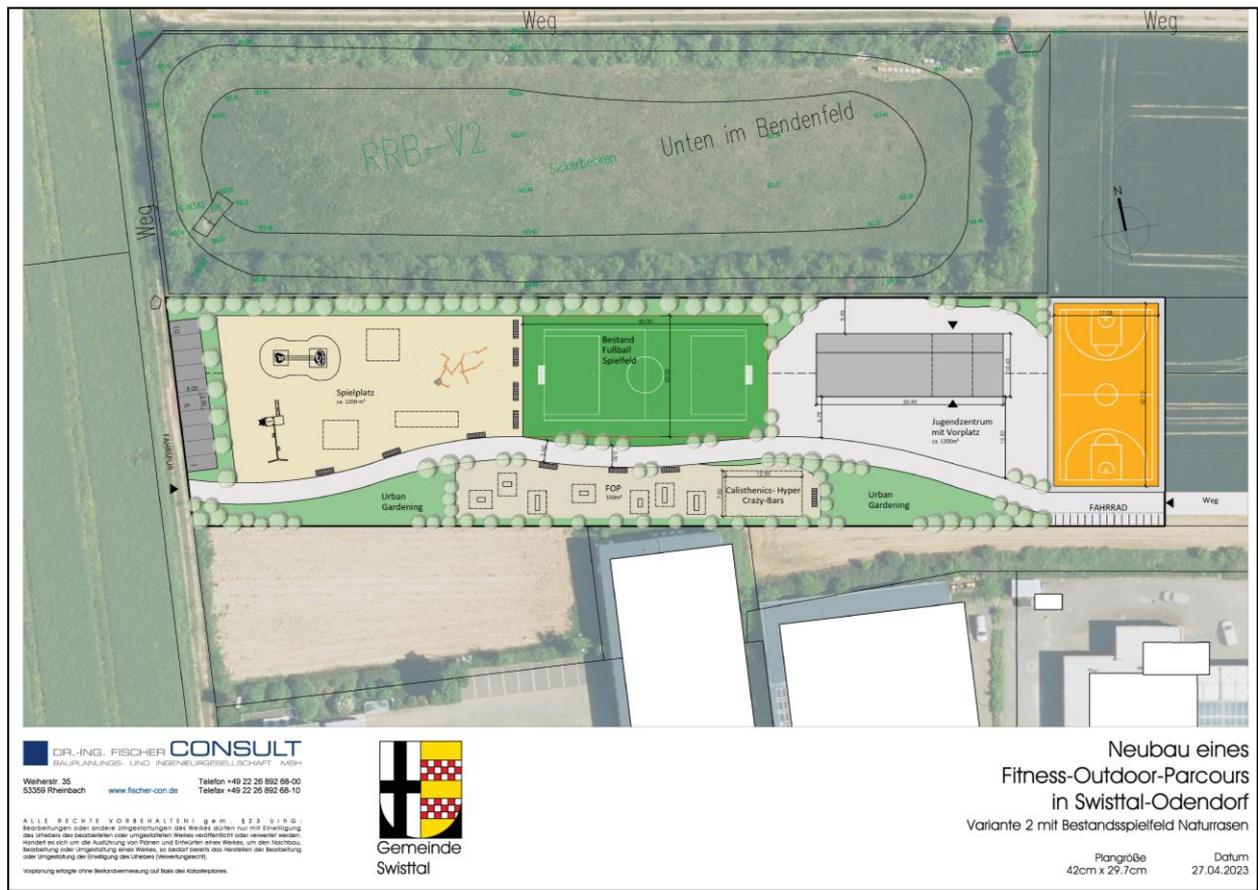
Heranzuziehende Plangrundlage – Lageplan zum „Neubau eines Fitness-Outdoor-Parcours in Swisttal-Odendorf, Variante 2 mit Bestandsspielfeld Naturrasen“ (Stand: 27.04.2023) [24]
